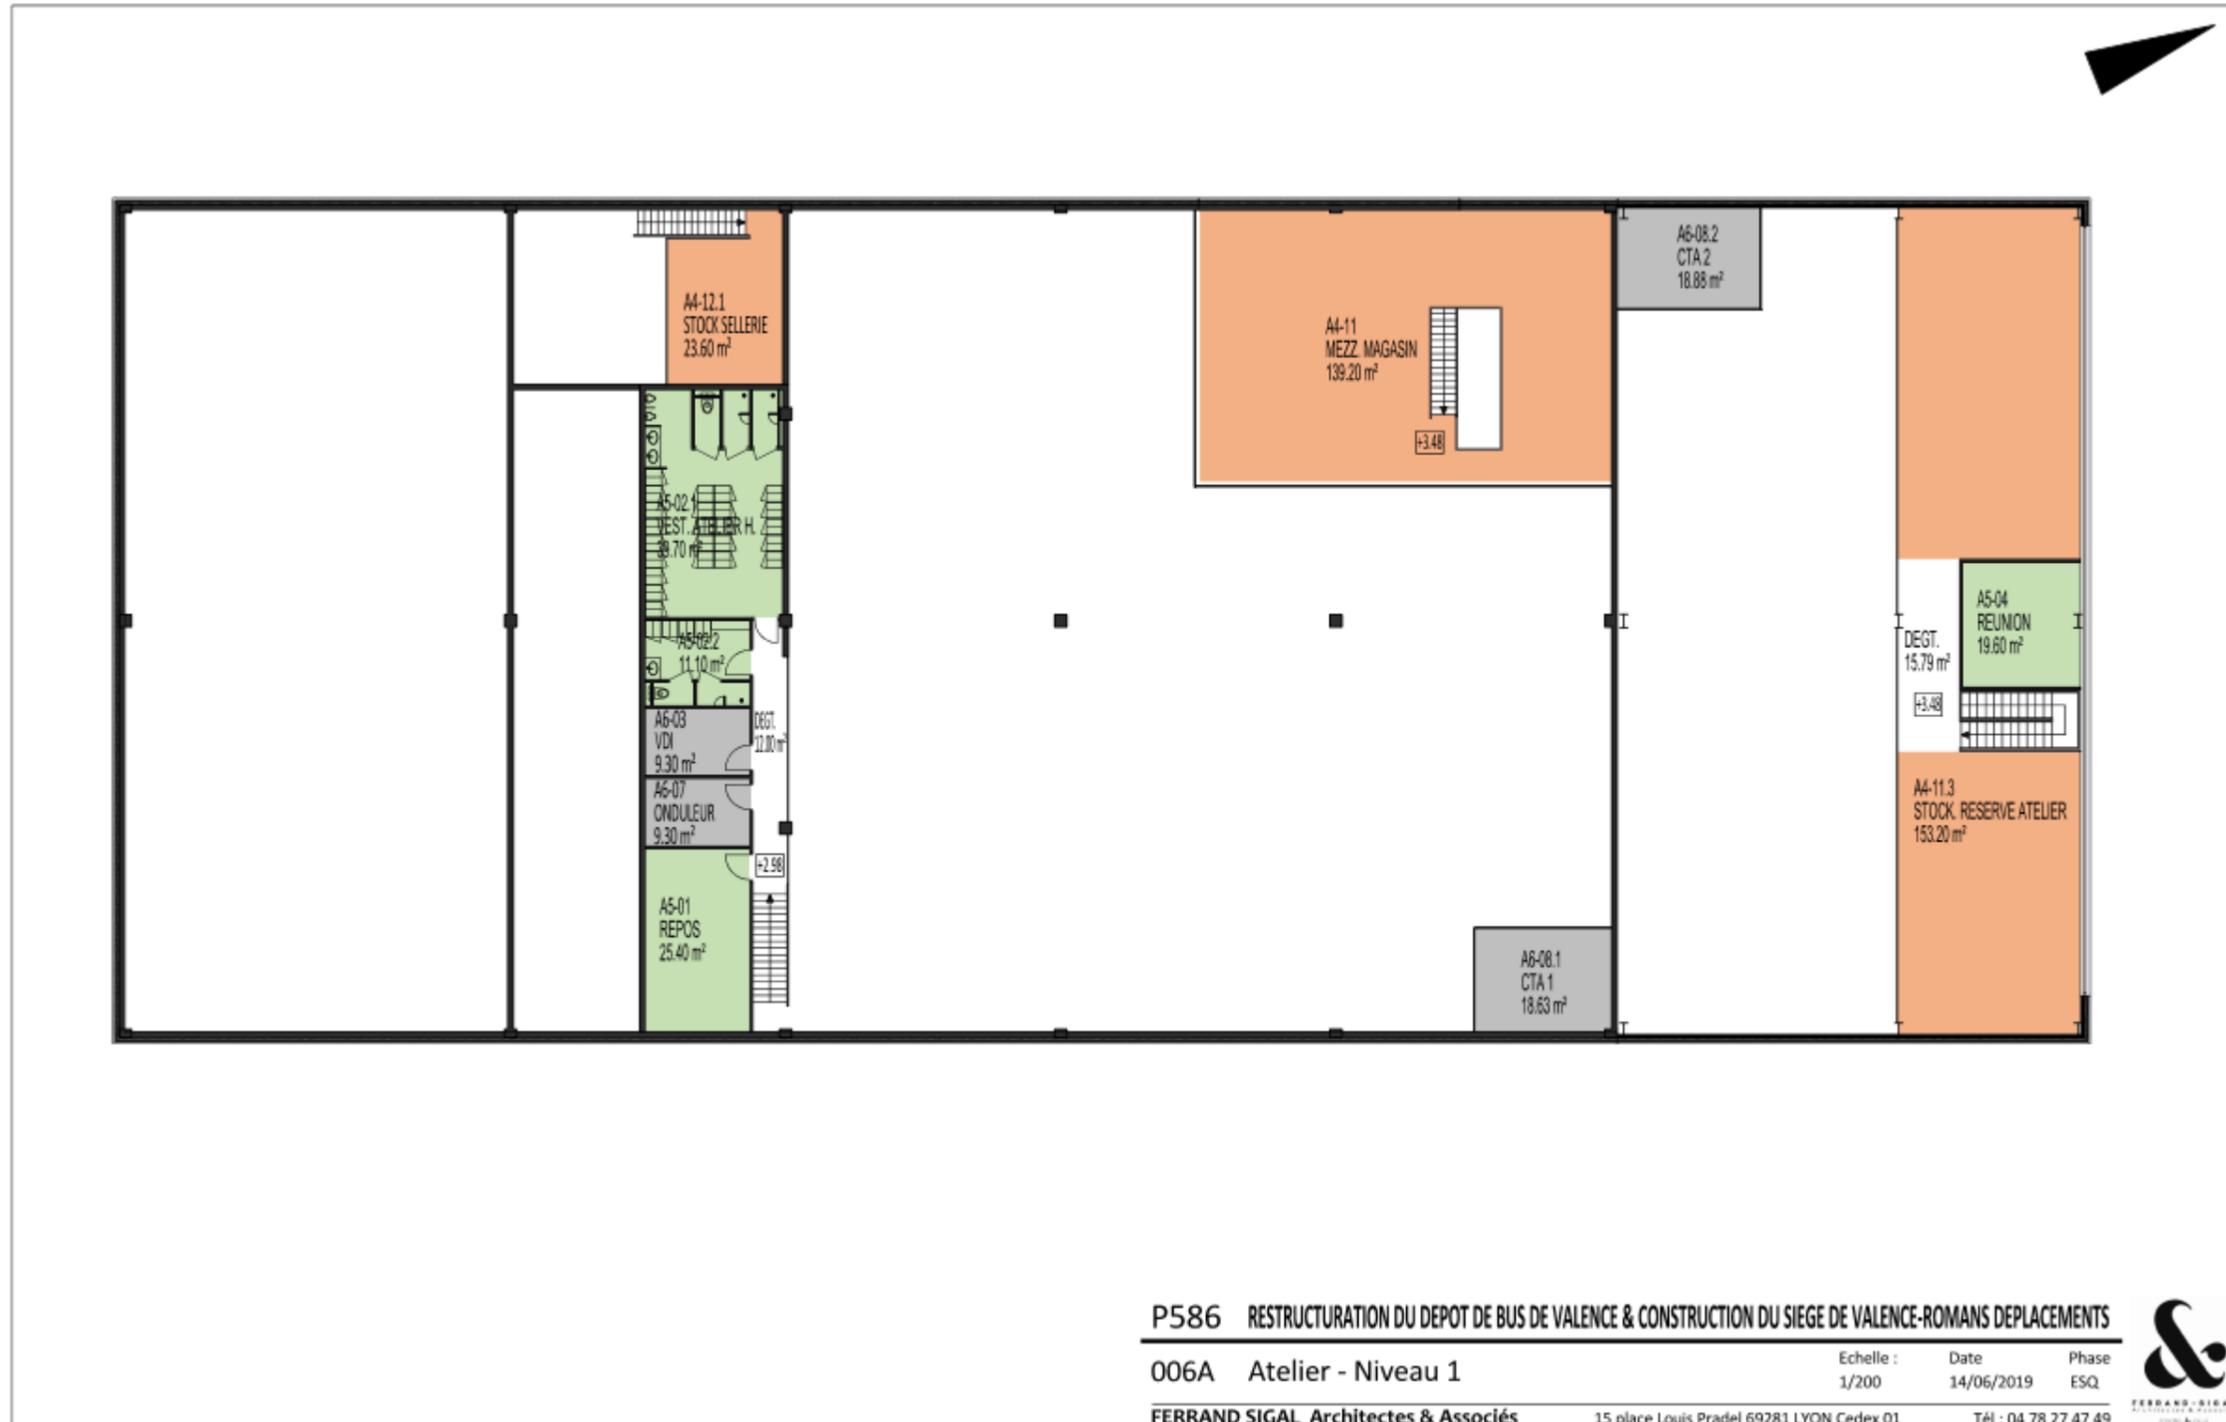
Plan Atelier – R+1 (Ferrand-Sigal, 2019)
